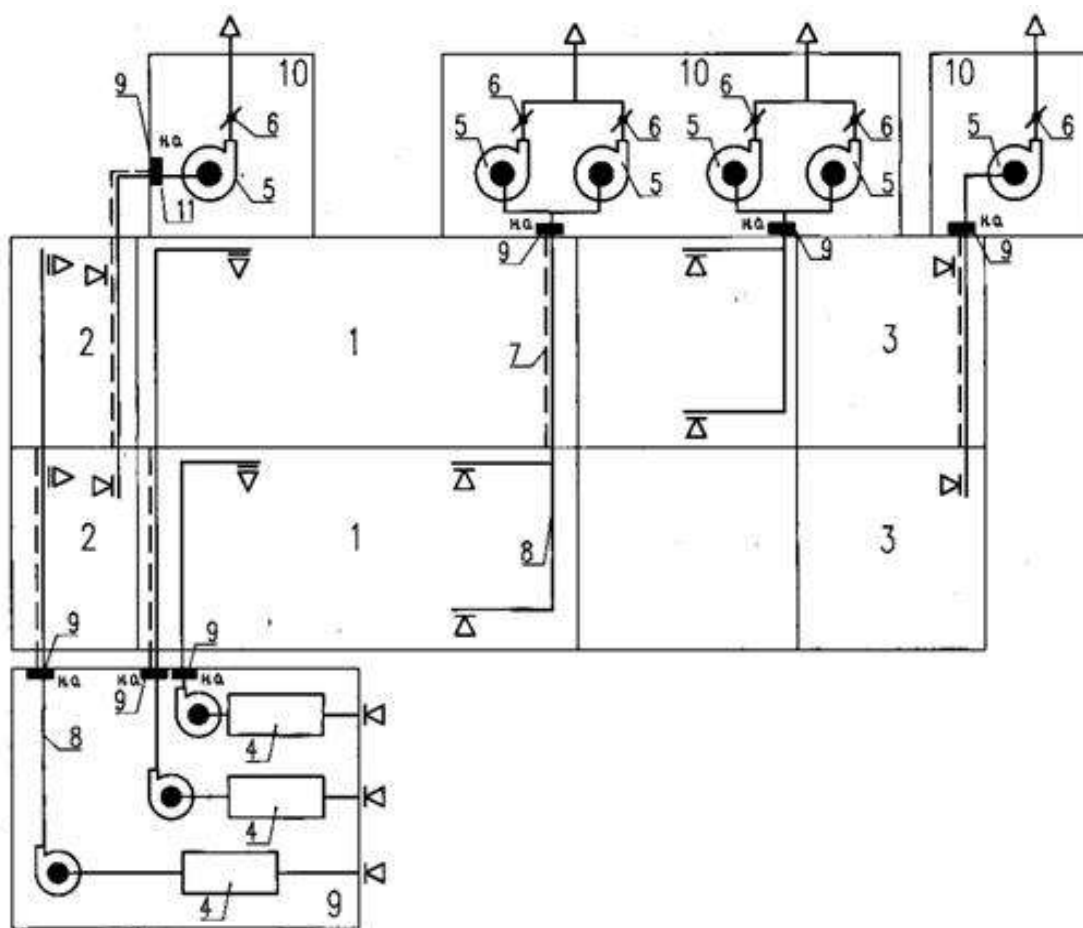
Принципиальные схемы систем вентиляции подземных стоянок автомобилей (2- и более этажных): 1 — помещение автостоянки (первого и второго этажей); 2 — спринклерная, ИТП и другие помещения, требующие приточной и вытяжной вентиляции; 3 — технические помещения, эл. щитовая — помещения, требующие только вытяжную вентиляцию; 4 — приточные установки; 5 — вытяжные вентиляторы; 6 — обратный клапан у вентилятора; 7 — транзитный воздуховод с нормируемым пределом огнестойкости; 8 — воздуховод в пределах одного помещения; 9 — противопожарный клапан; 10 — помещения для вентиляционного оборудования
